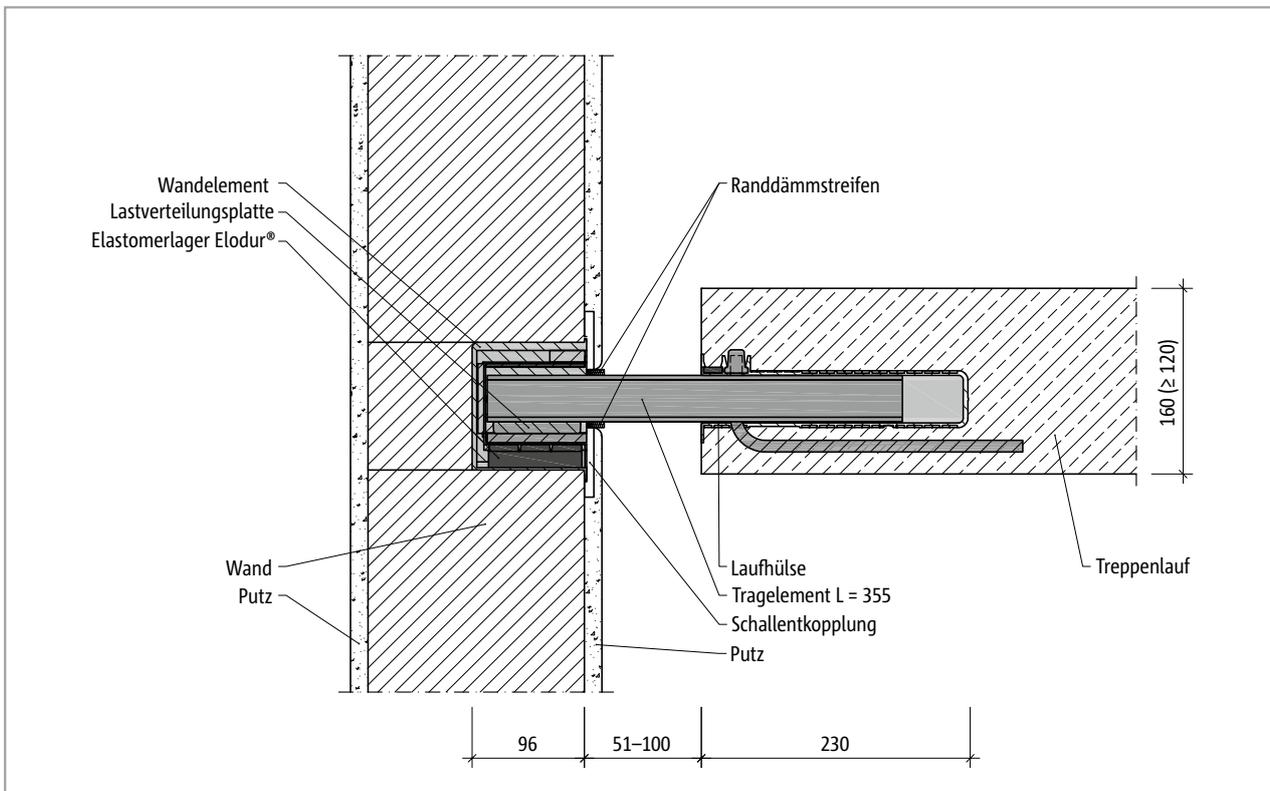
Schöck Tronsole® Typ Q-FV-XL oder Q-A2-XL: Einbauschnitt
